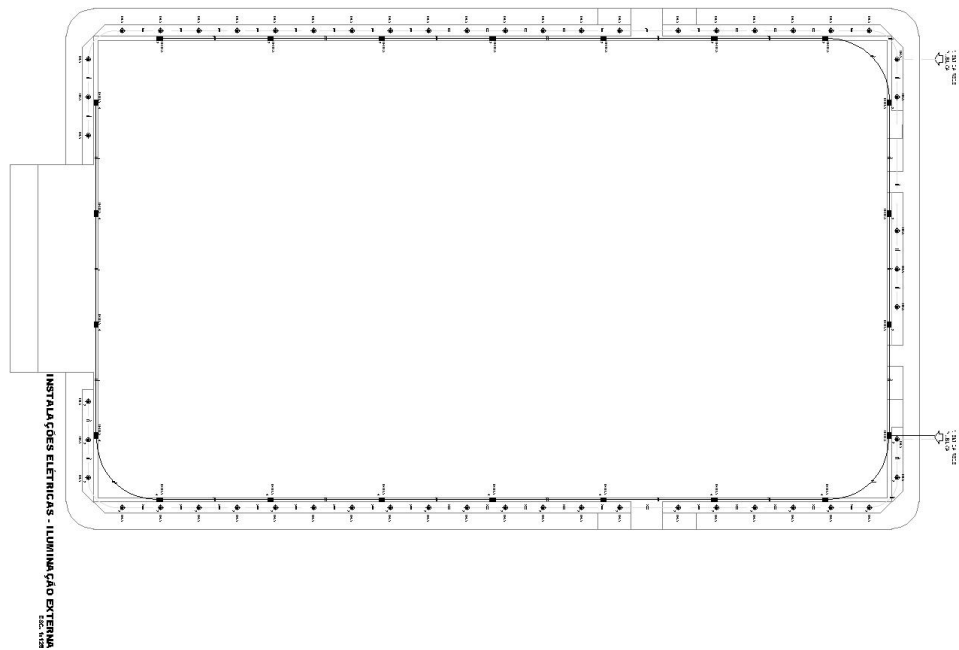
Planta de Instalações Elétricas – Iluminação Externa
